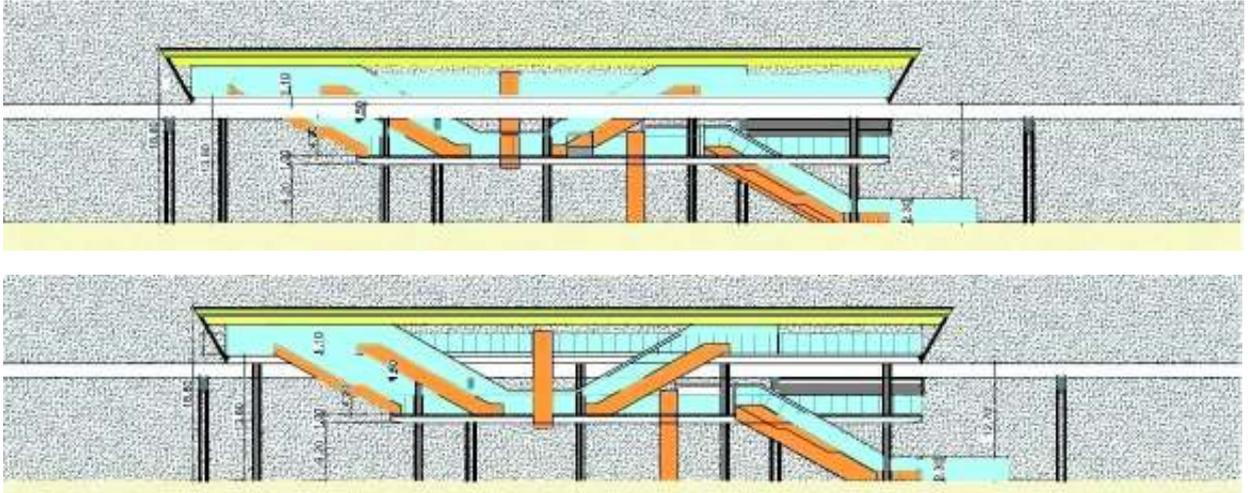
Desenho da Estação Padrão – Cortes Longitudinais.
